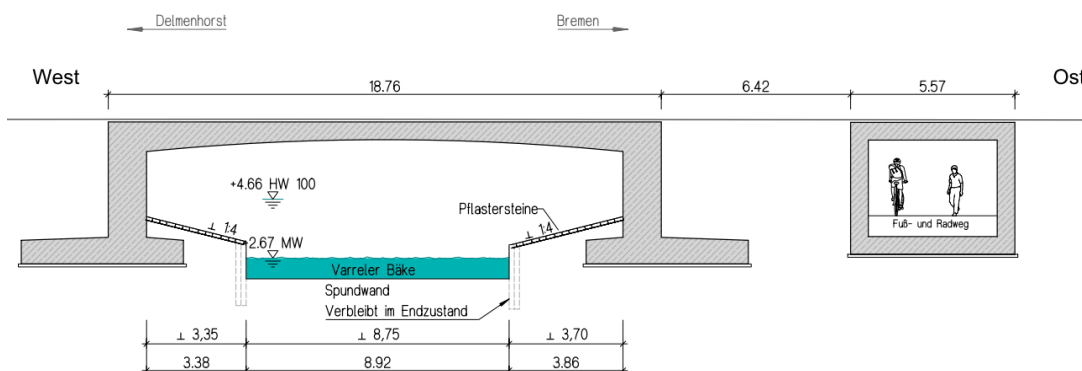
Planung des Ersatzneubaus BW 443 - 443 – Längsschnitt Rahmentragwerk und Unterföhrungsbauwerk
